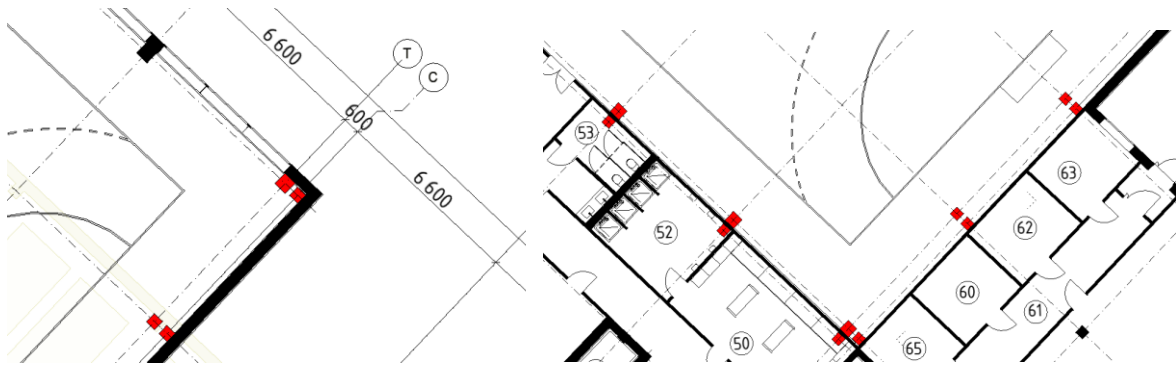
Схема деформаційного шву на плані 1-го поверху будівлі
